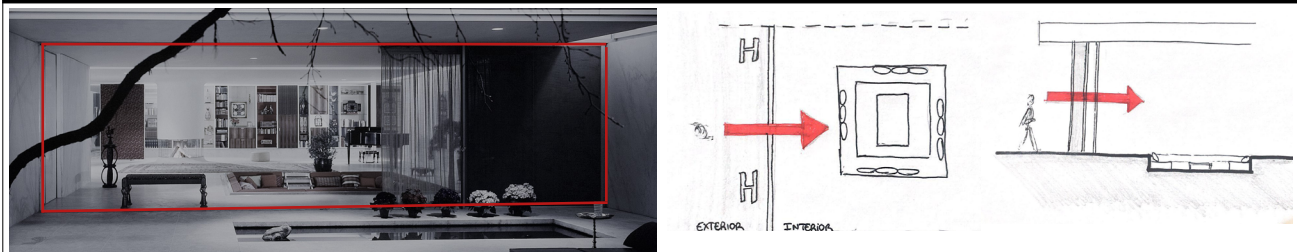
Vista de la fachada del edificio. Modificado por el autor
